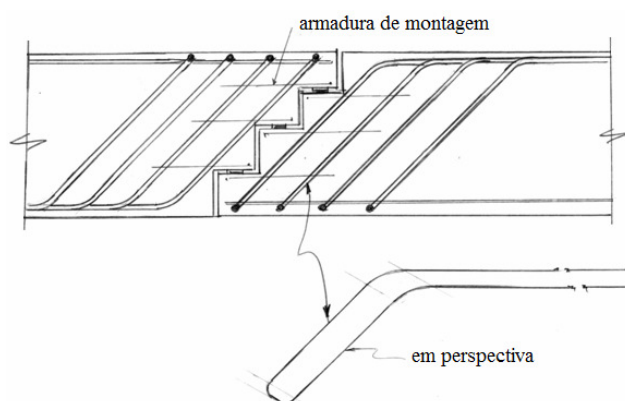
Detalhe da armadura interna em laço proposta para vigas de concreto armado.
